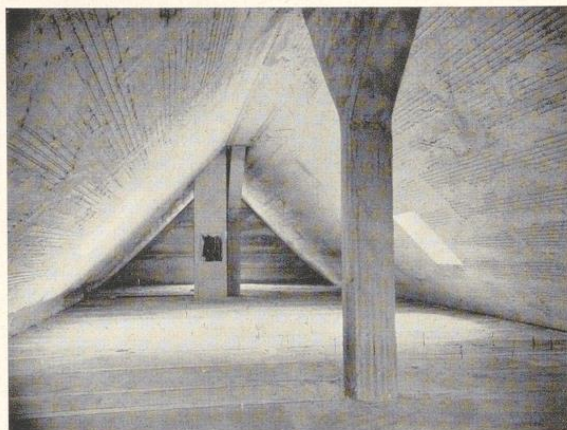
Dachraum, mit Gipsdielen vollständig ausgekleidet
